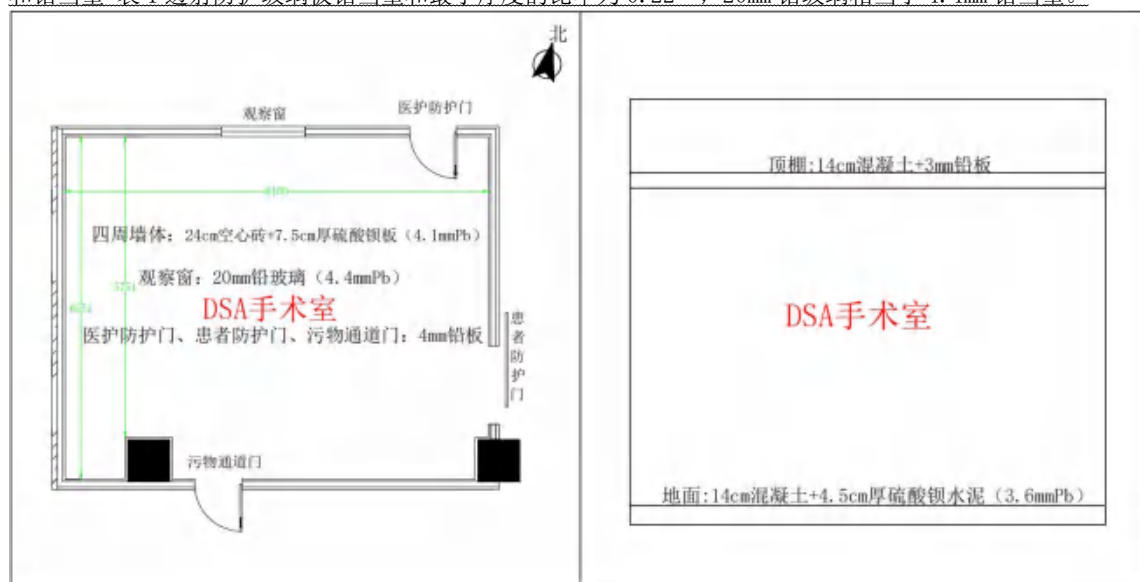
本项目 DSA 手术室四周墙体防护结构平面图及剖面图
